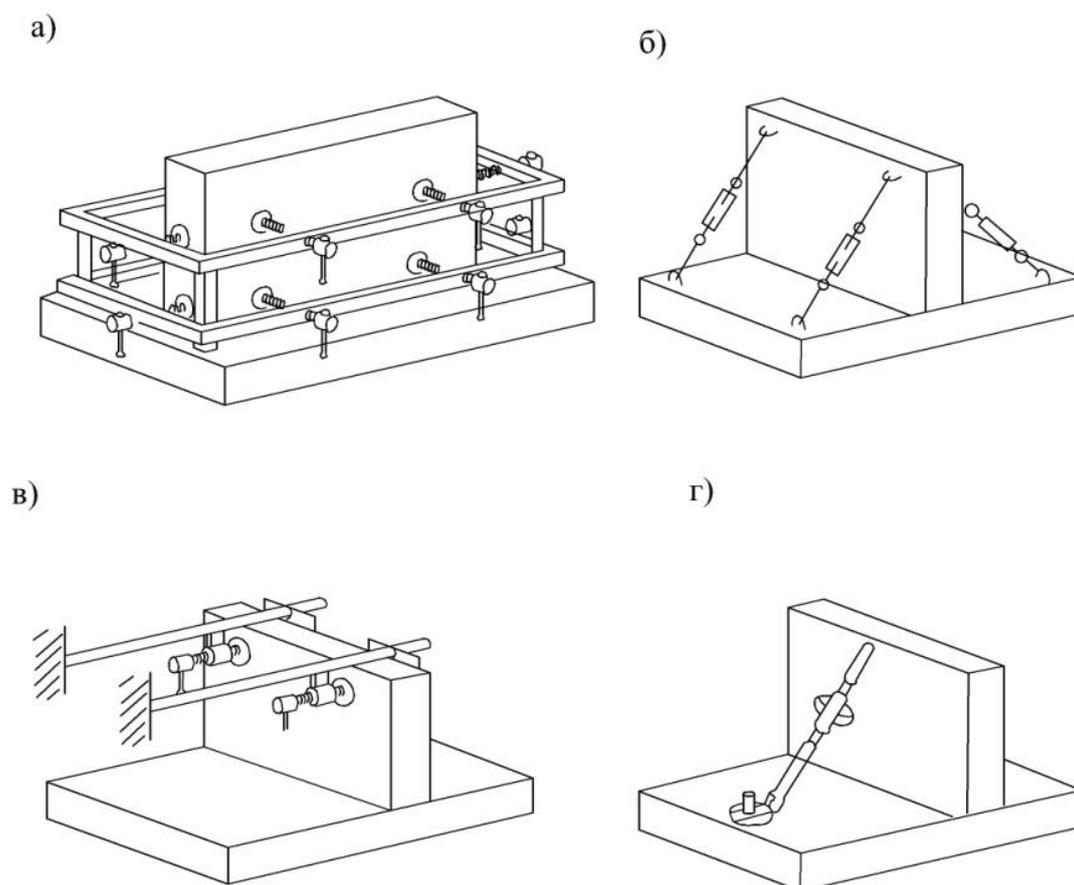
Схемы применения индивидуальных крепёжных приспособлений при монтаже стеновых панелей крупнопанельного здания:
